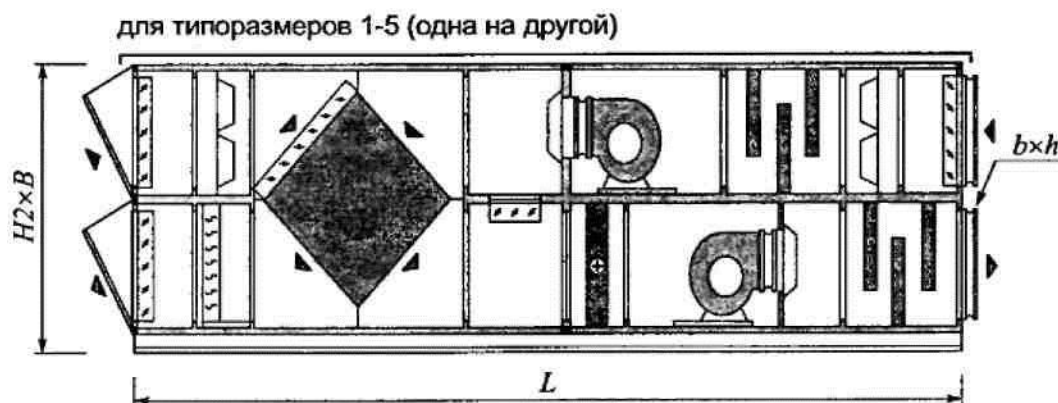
Схема приточно-вытяжной установки с встречным движением приточного и удаляемого потоков и с расположением отверстий приема и выдачи воздуха в линию с осью движения потоков
